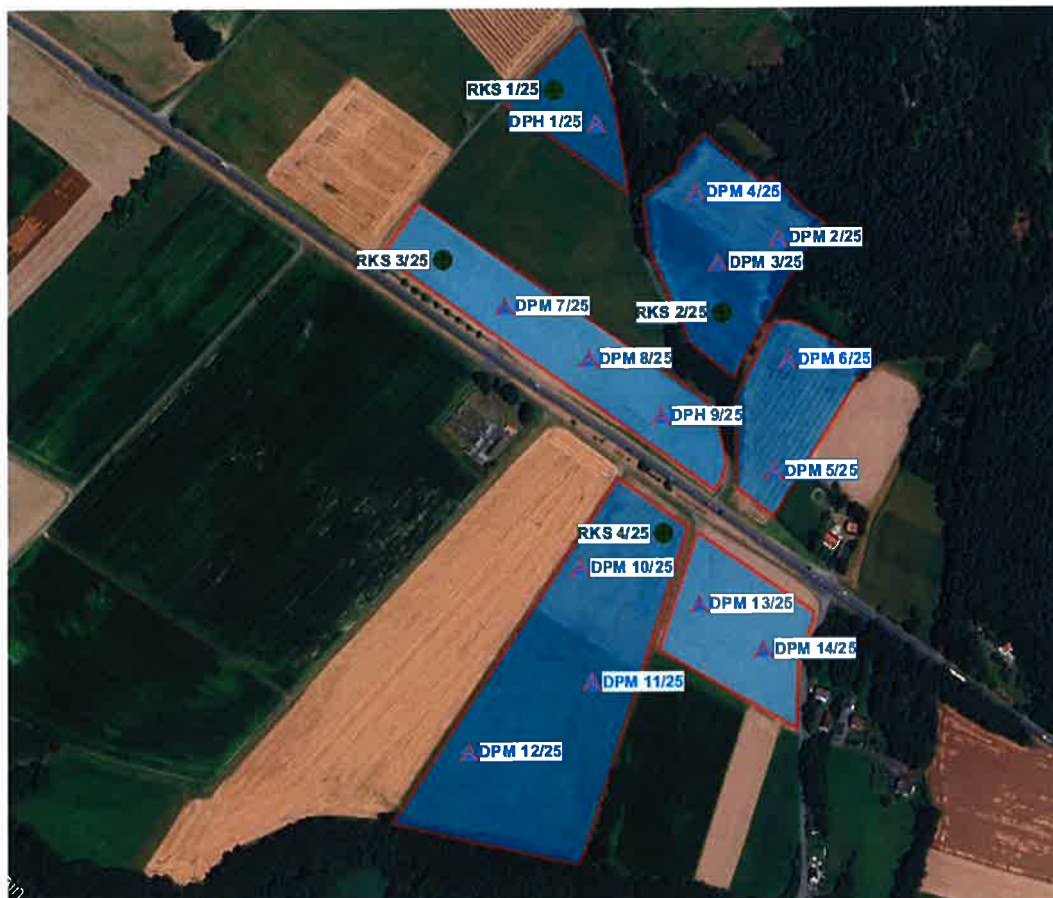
Lageplan mit Untersuchungspunkten der geotechnischen Erkundungen des Baugrunds [U 14].
